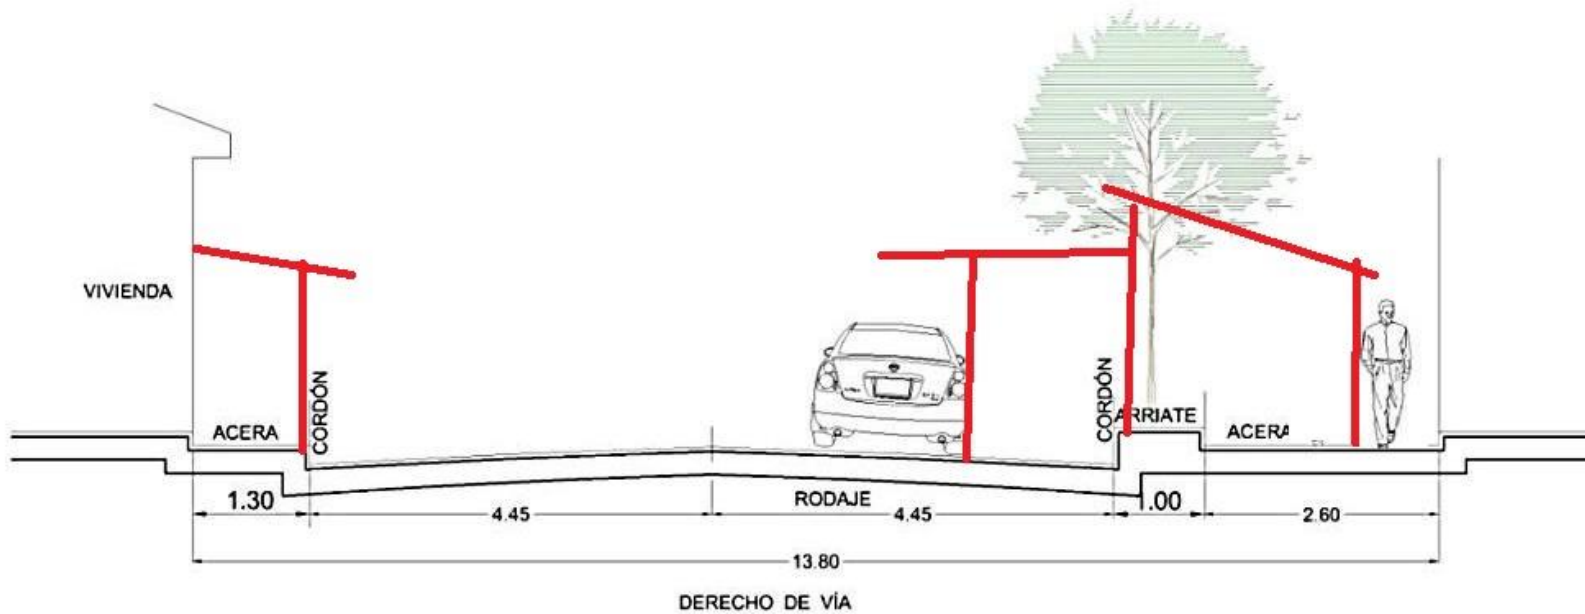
Esquema del perfil de la utilización de las calles en Mejicanos
